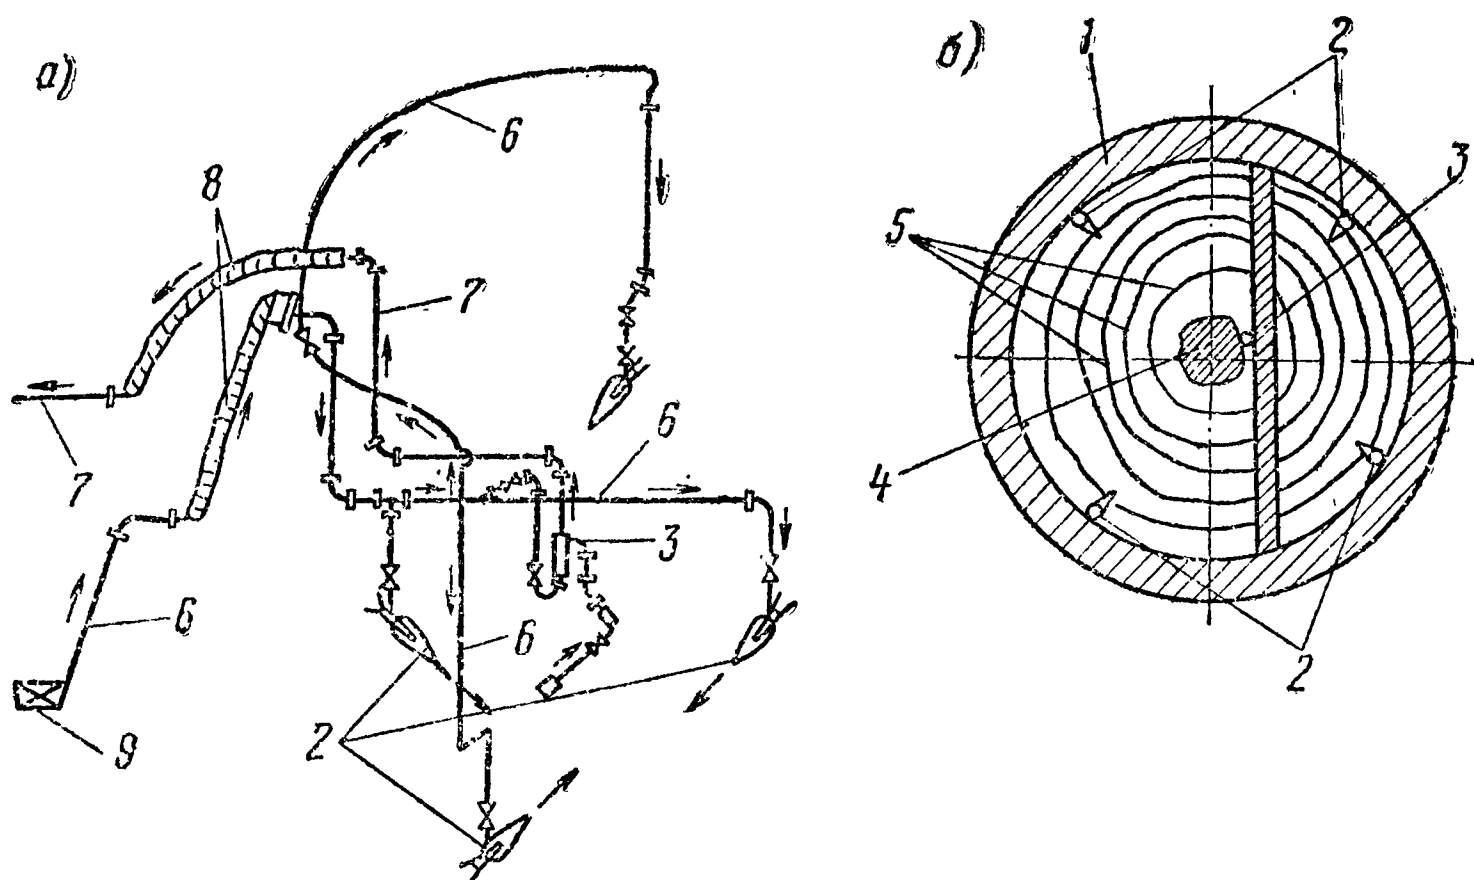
Технологическая схема разработки грунта в опускном колодце с помощью гидромониторов и гидроэлеваторов
